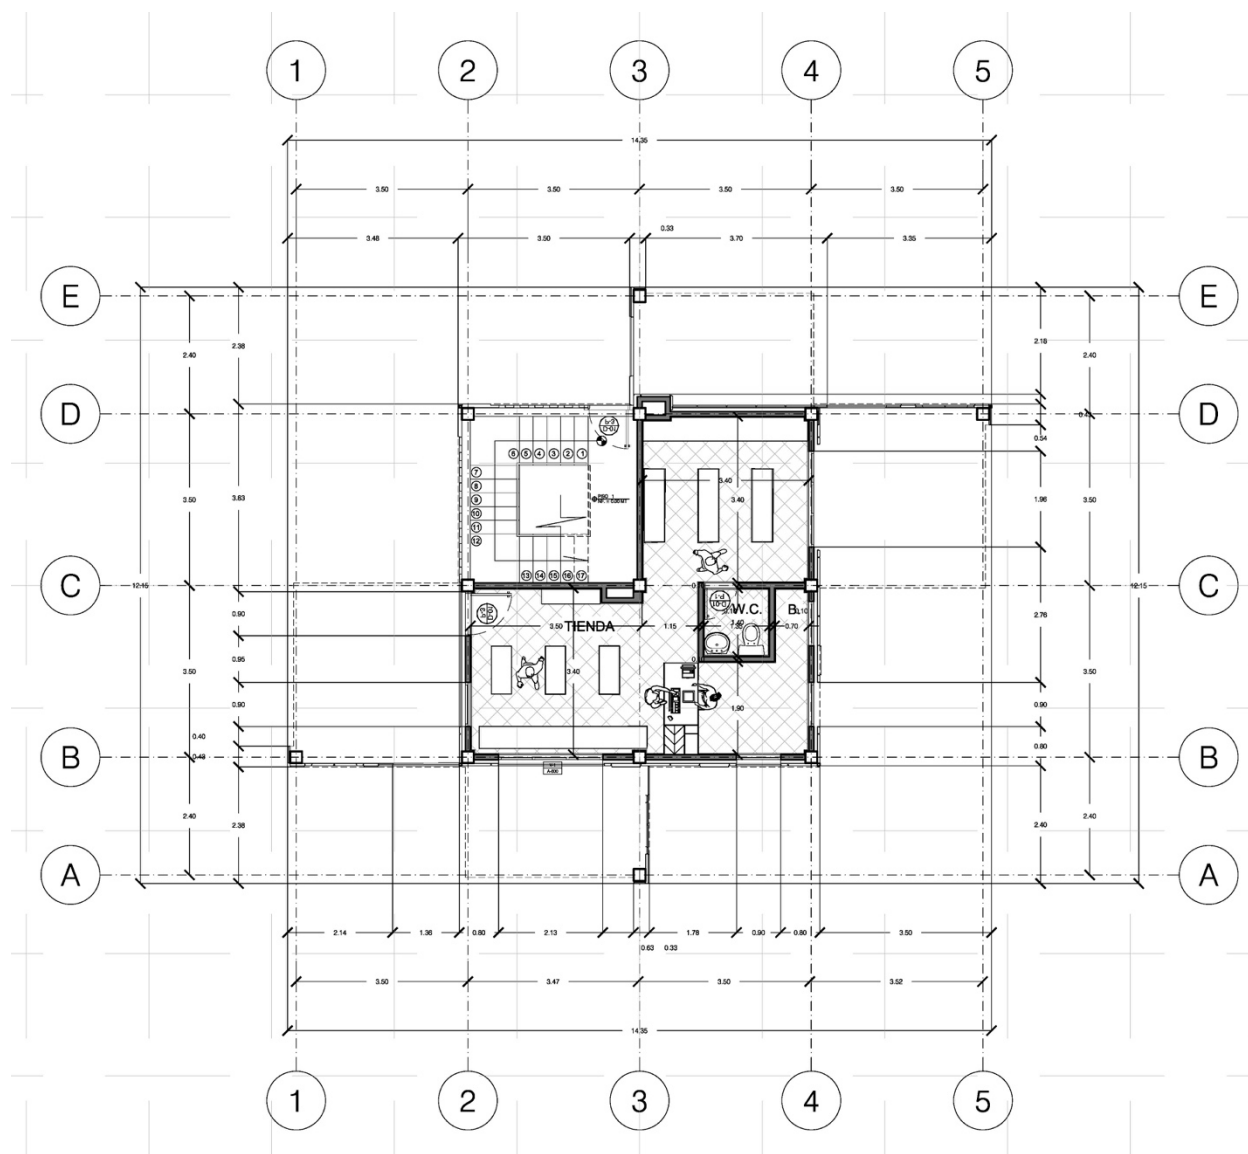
Planta arquitectónica primer piso “Zona productiva de uso mixto (comercio)”
